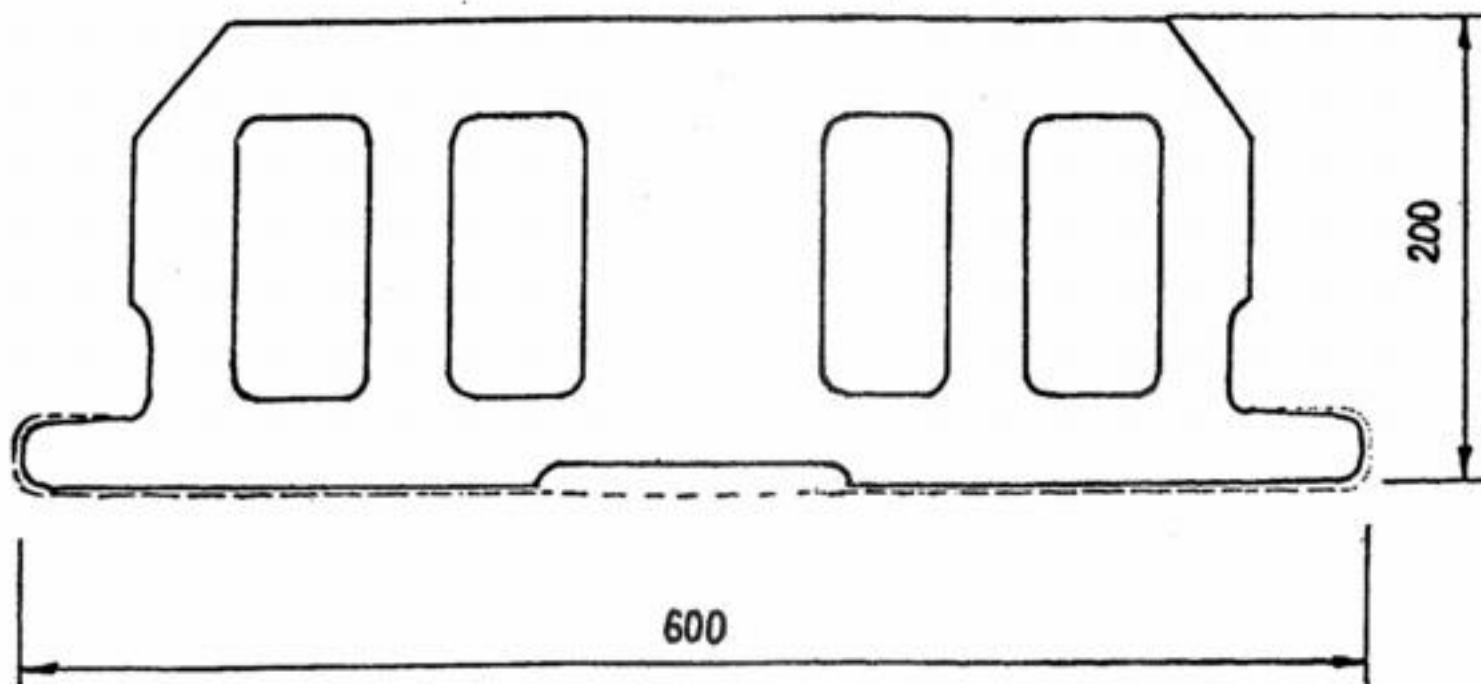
а - Элемент опалубочный перекрытия шириной 600 мм.
